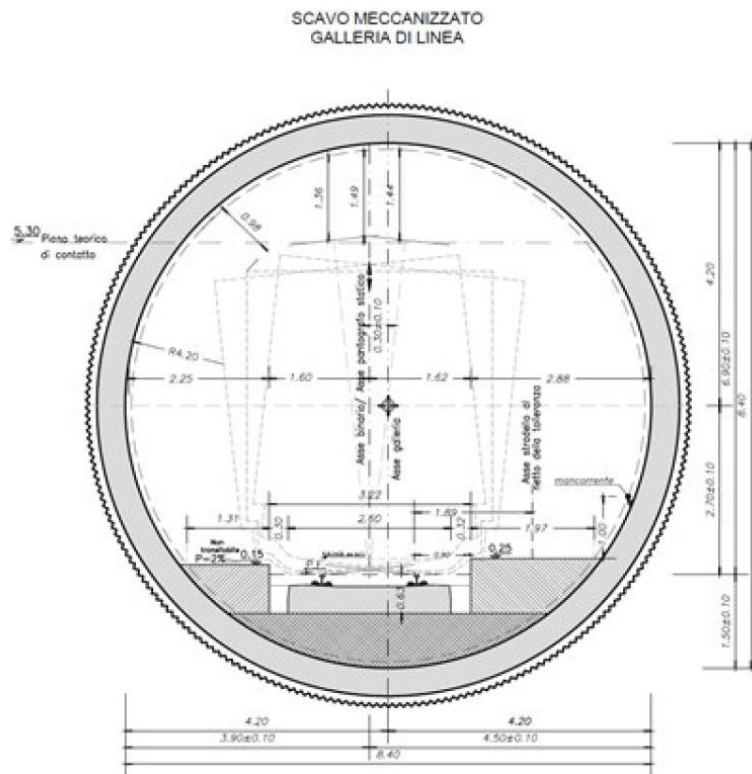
Sezione tipo di intradosso galleria a semplice binario. Scavo meccanizzato.
